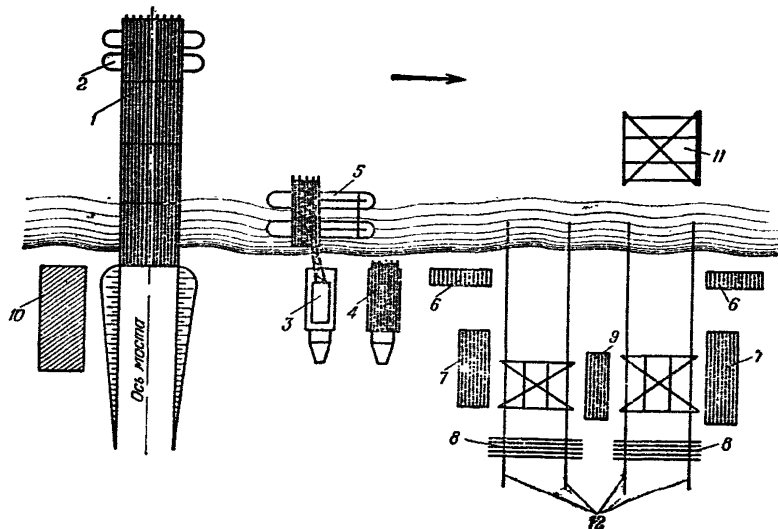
Схема организации строительной площадки при строительстве моста на рамных опорах:
